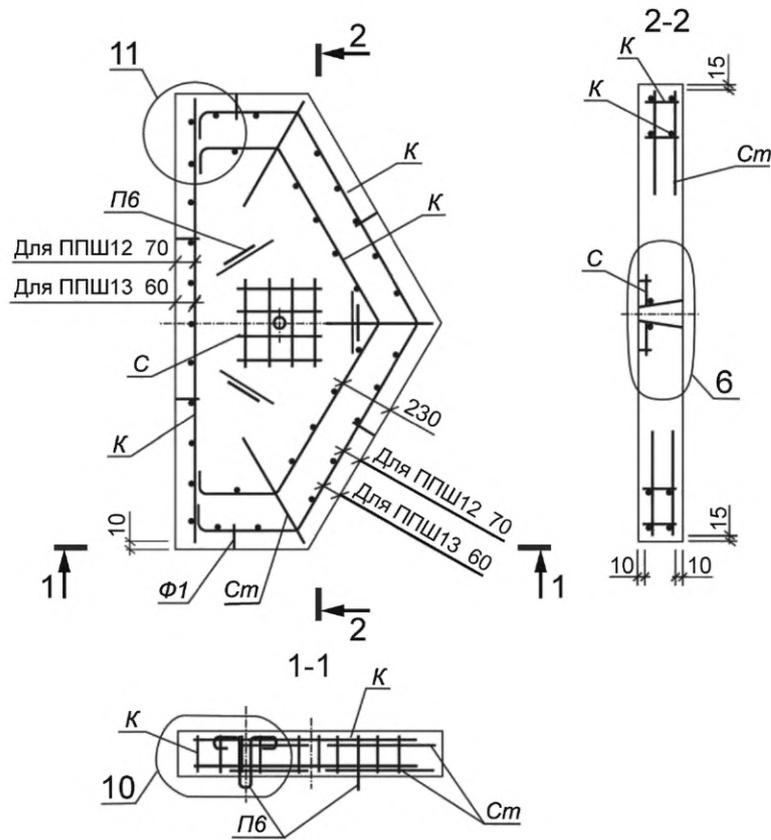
Схема армирования плит: ППШ13, ППШ12
